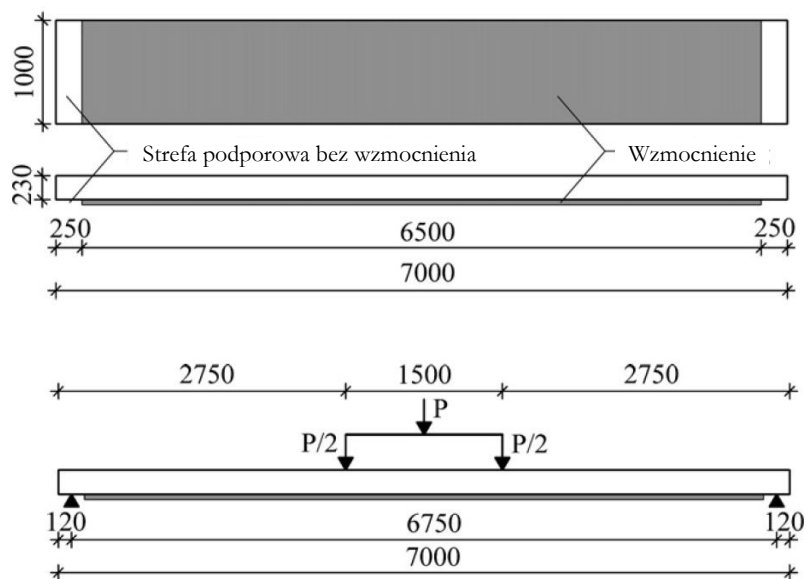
Geometria zbrojenia elementów badawczych [63]
